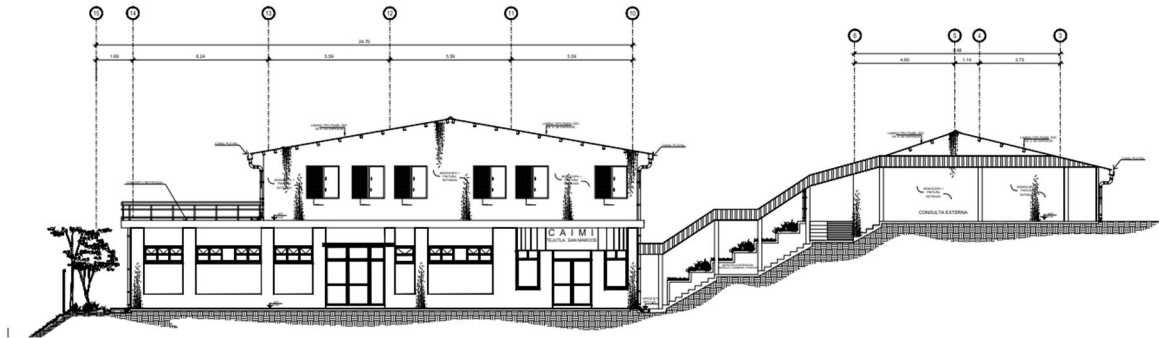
Elevación principal, Conjunto CAIMI; Fuente: SNIP - SEGEPLAN, elevaciones y secciones
